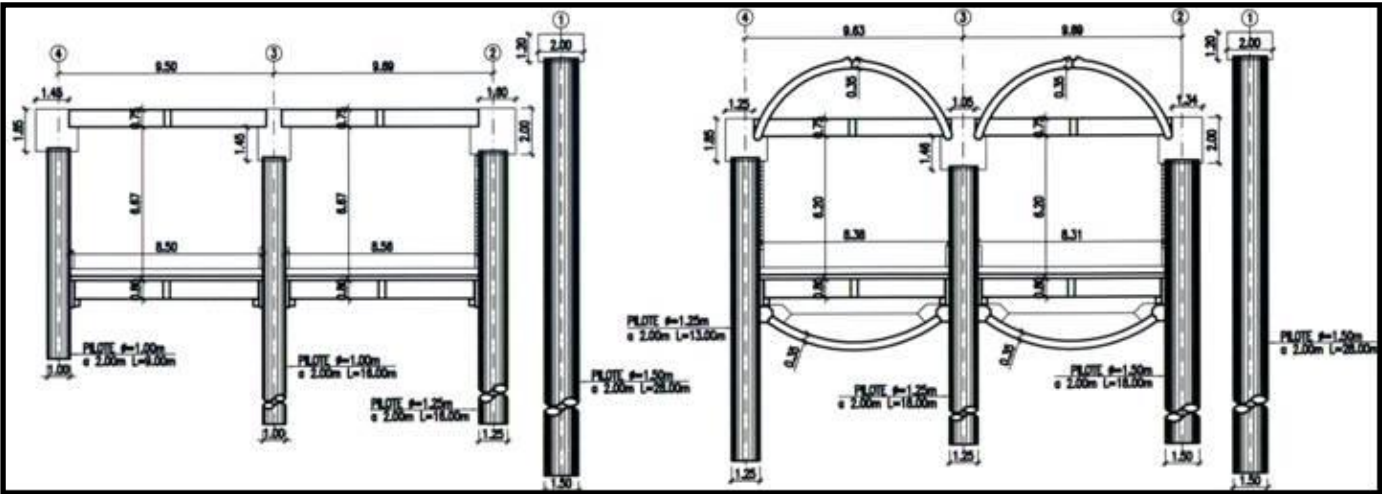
Etapa Final, construcción de las secciones completas del túnel y posterior relleno de contrapeso en la zona superior de las bóvedas. Fuente G y C 2008
